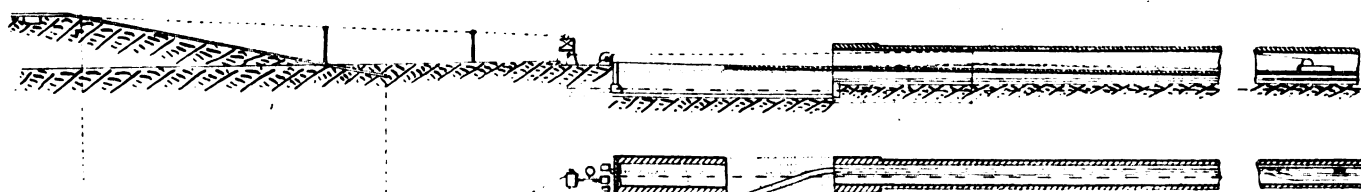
et 19. — Profil et plan de l'installation du transport des déblais.
